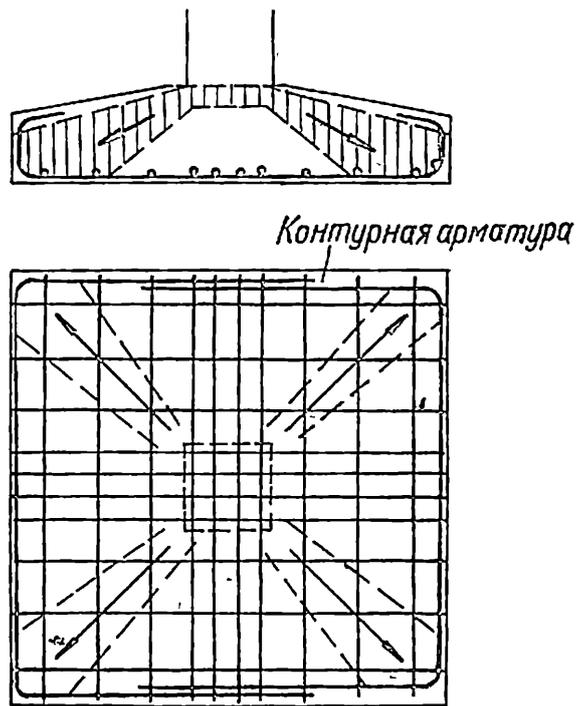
9. Контурная арматура для дополнительного восприятия усилий от пирамиды сжатия по углам
